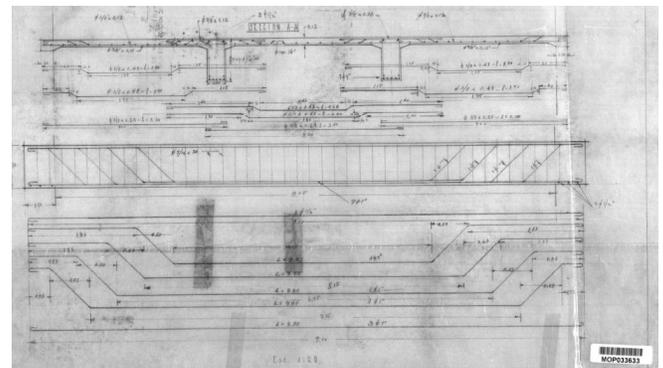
Detalle vigas sistema Weyss de hormigón armado en Congreso Nacional (1936). Fuente: Archivo DEPA MOP
